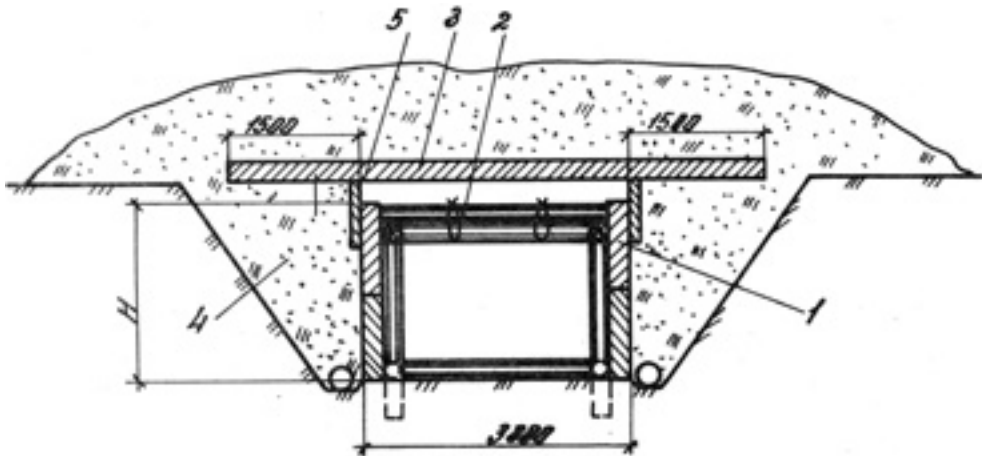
Убежища с податливым покрытием: 1 – панели стен; 2 – покрытие из бревен; 3 – железобетонная плита; 4 – насыпной грунт; 5 – вертикальный элемент
